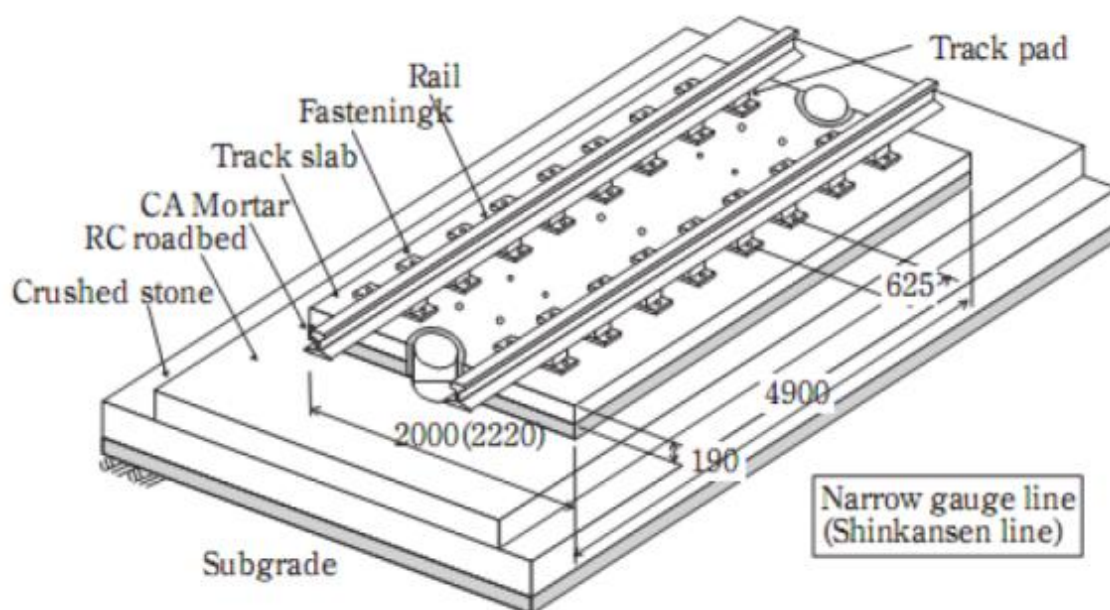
Esquema da solução japonesa J-Slab, vista lateralmente (Ando et al., 2001)
